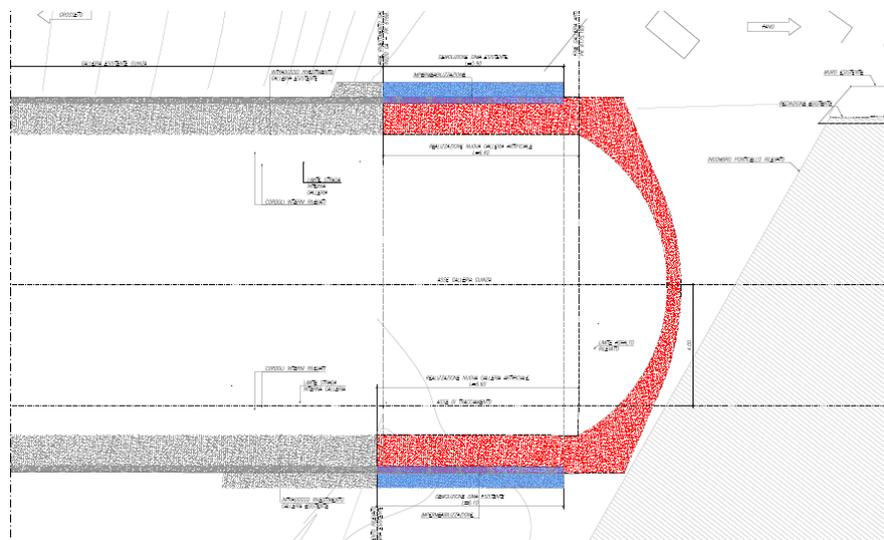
Galleria Guinza - Imbocco lato Marche - Planimetria galleria artificiale
